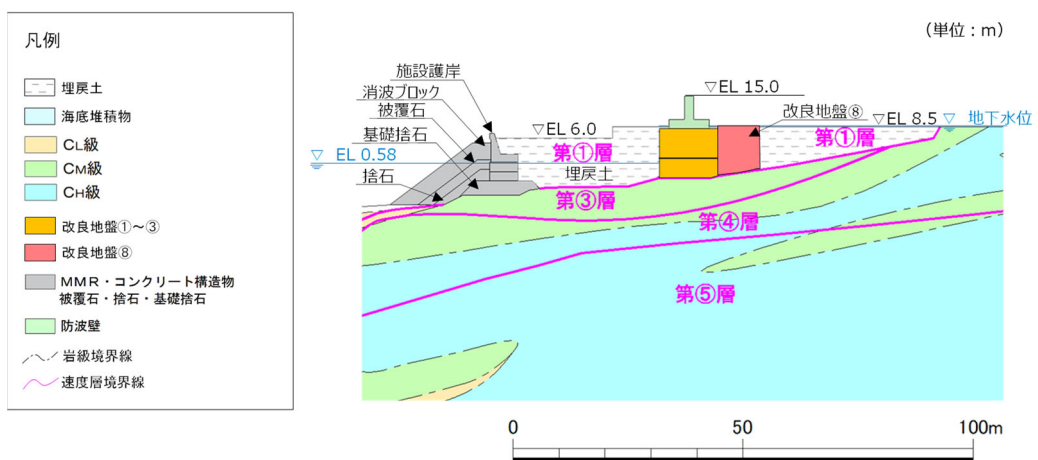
影響確認断面の地質断面図（①-①断面）
